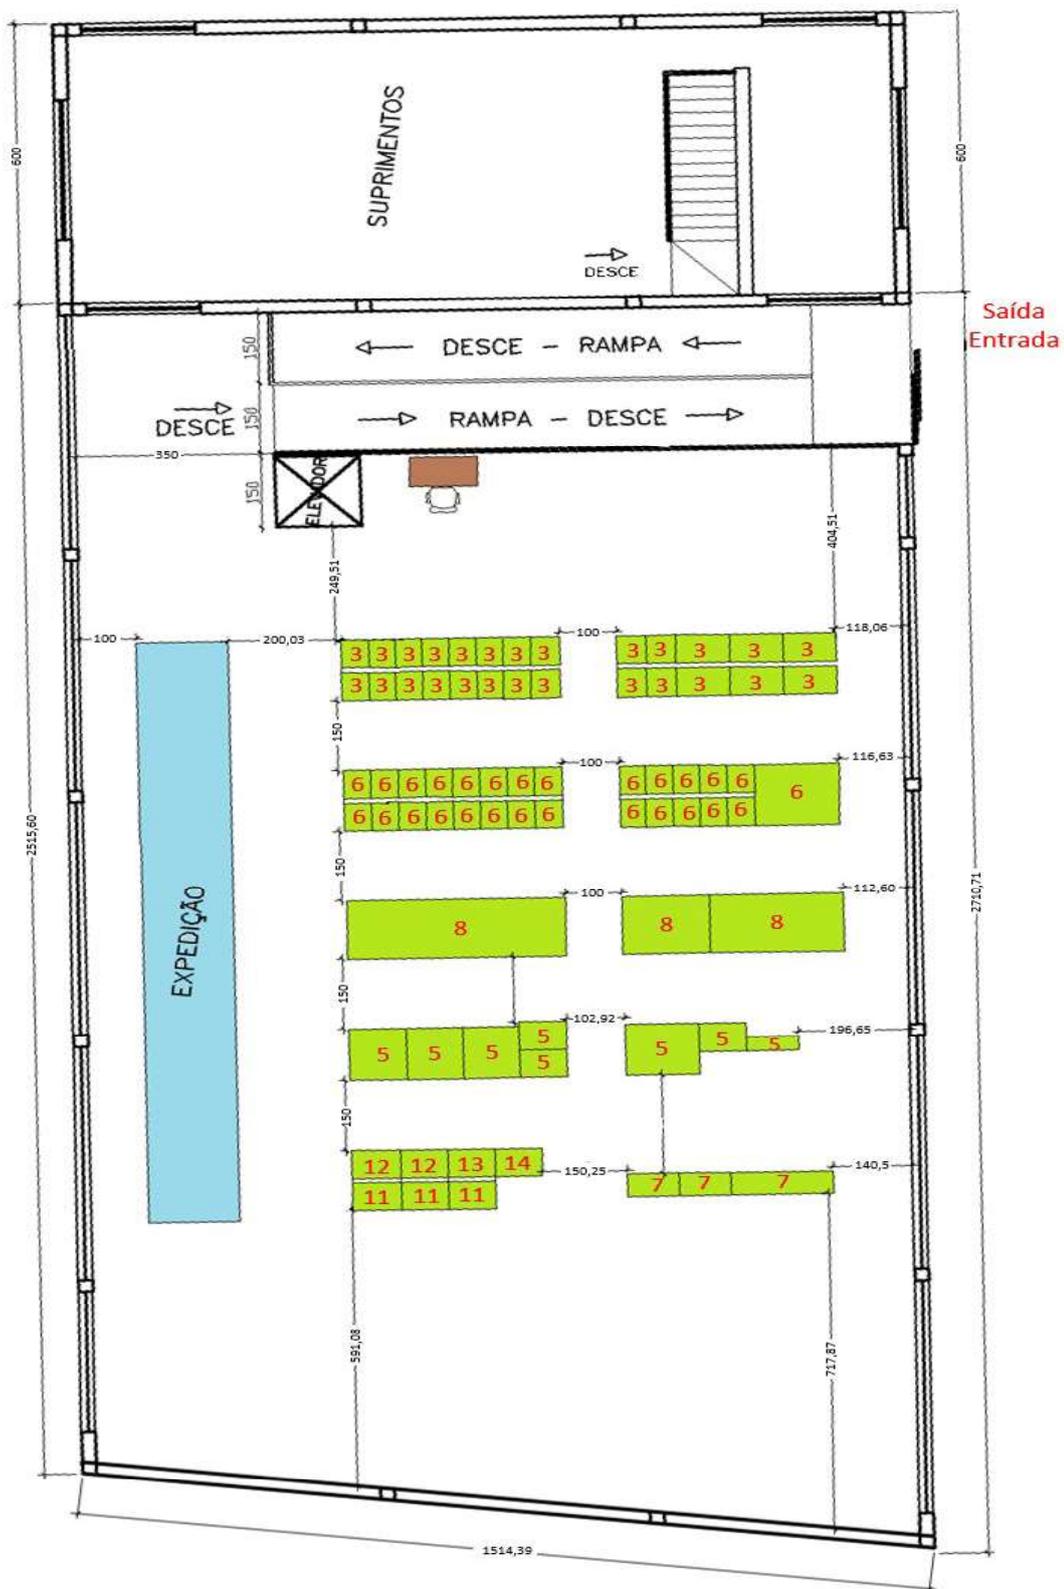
Layout* proposto para o primeiro pavimento do Almoarifado
